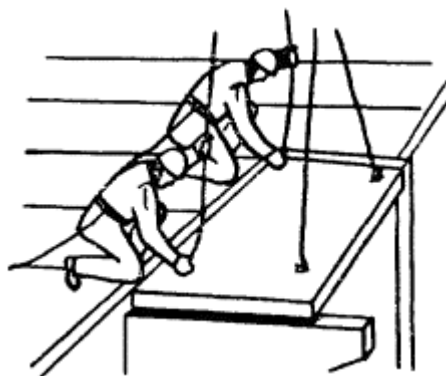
Розстроповка плити перекриття після монтажу
